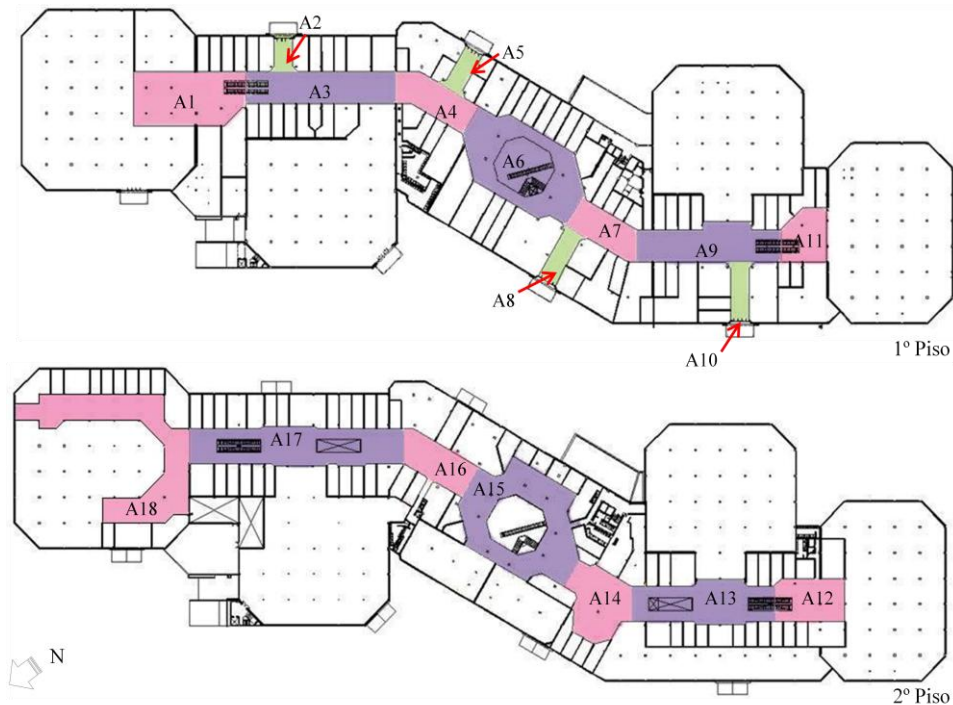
Planta baixa do Shopping Iguatemi dividida em dezoito áreas para levantamento *in loco*.
